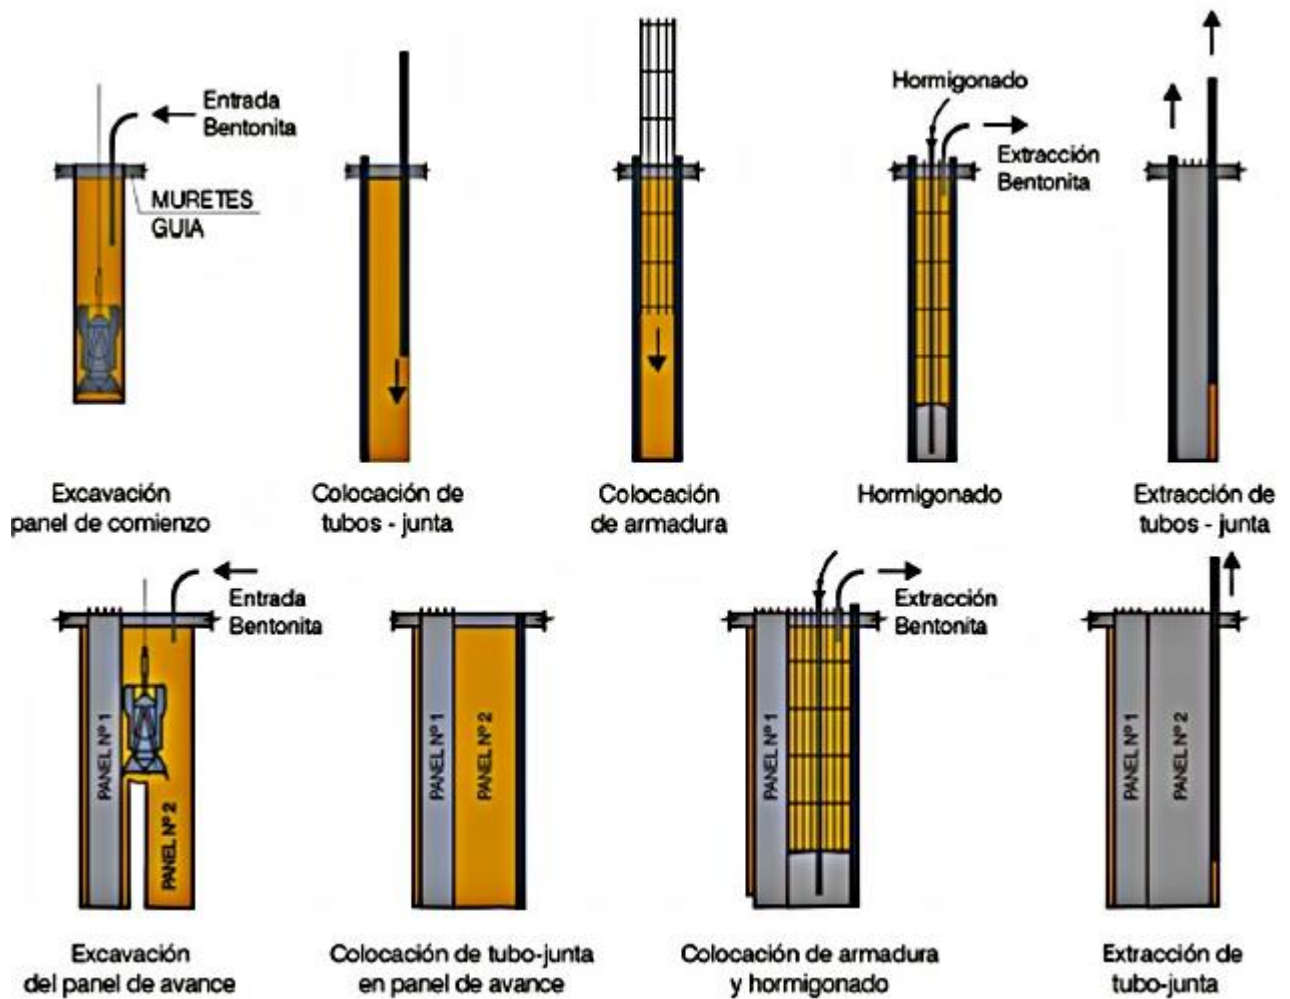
Proceso constructivo Muro Pantalla. Pilote Terratest (2010).
